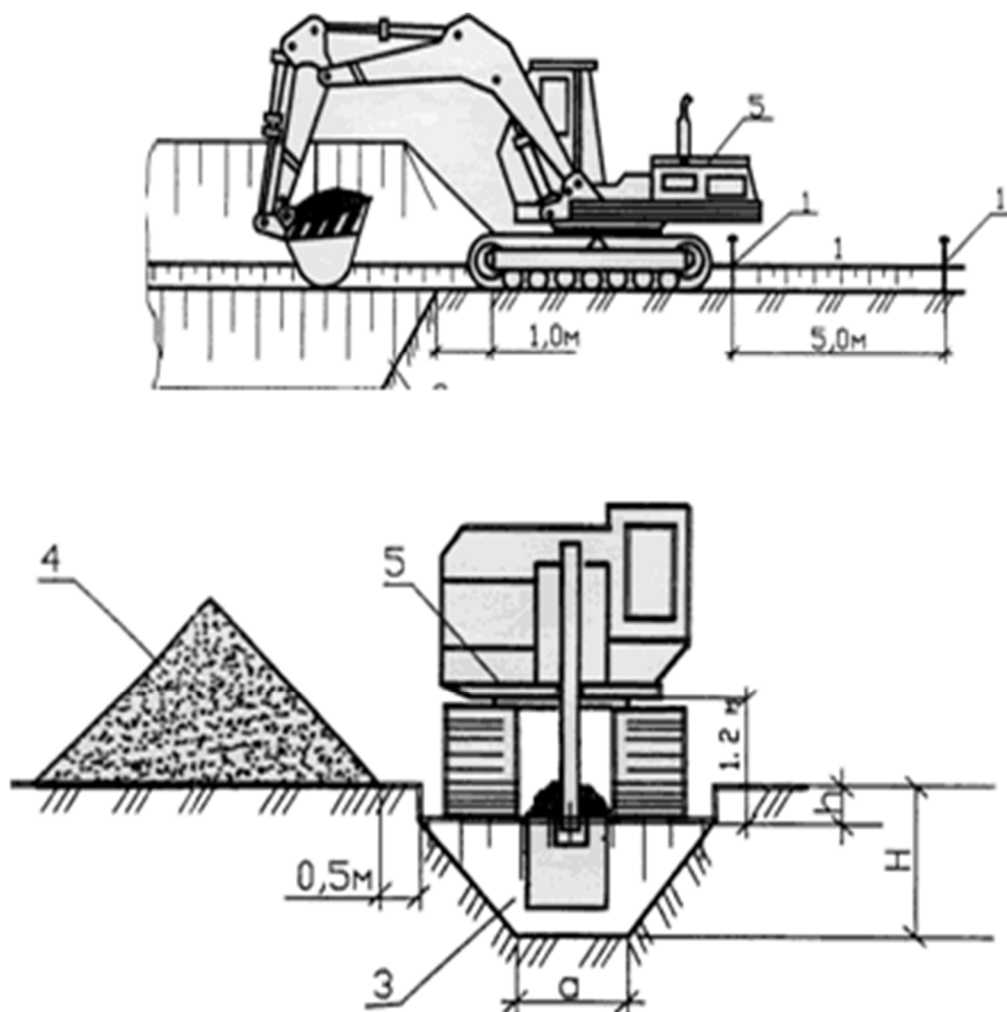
Схема разработке грунта траншей при лобовой проходке
